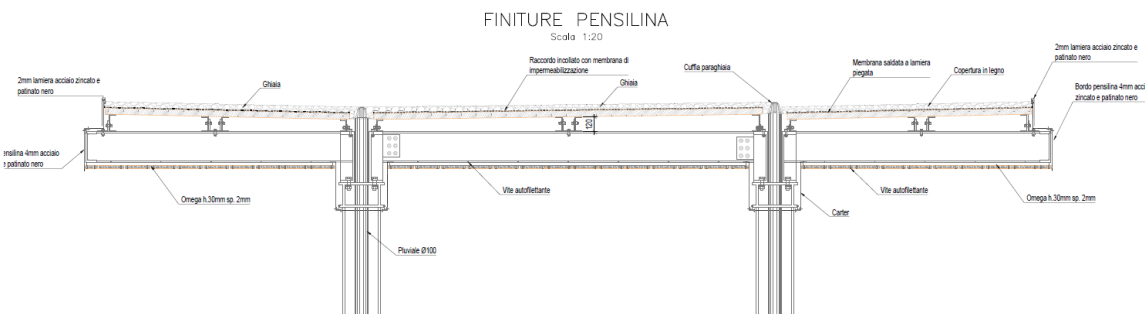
Dettaglio finitura copertura – Pensilina a doppia falda
